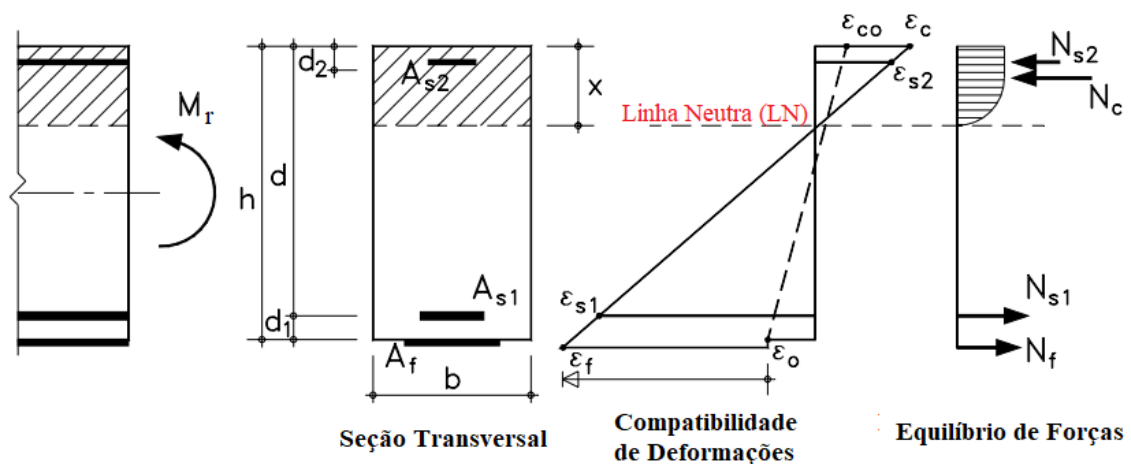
Seção transversal de elemento em concreto reforçado à flexão com FRP, Adaptado de MATTHYS (2000).
